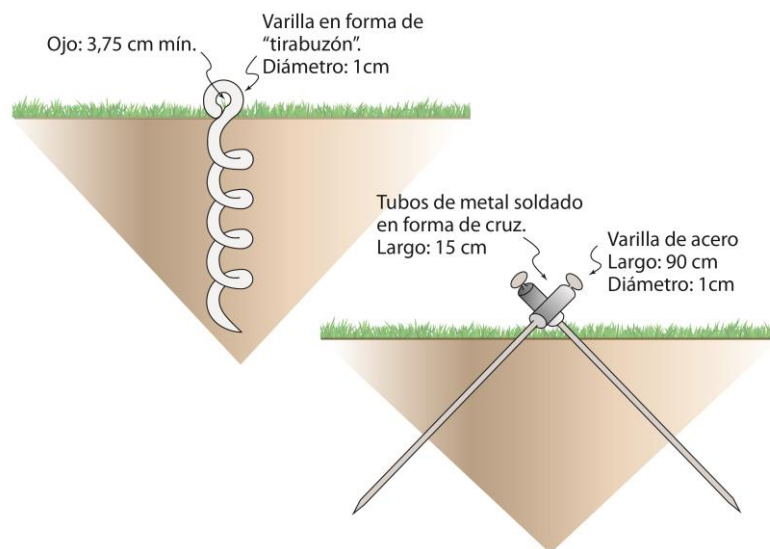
Dispositivos de amarre removible para superficies no pavimentadas.
